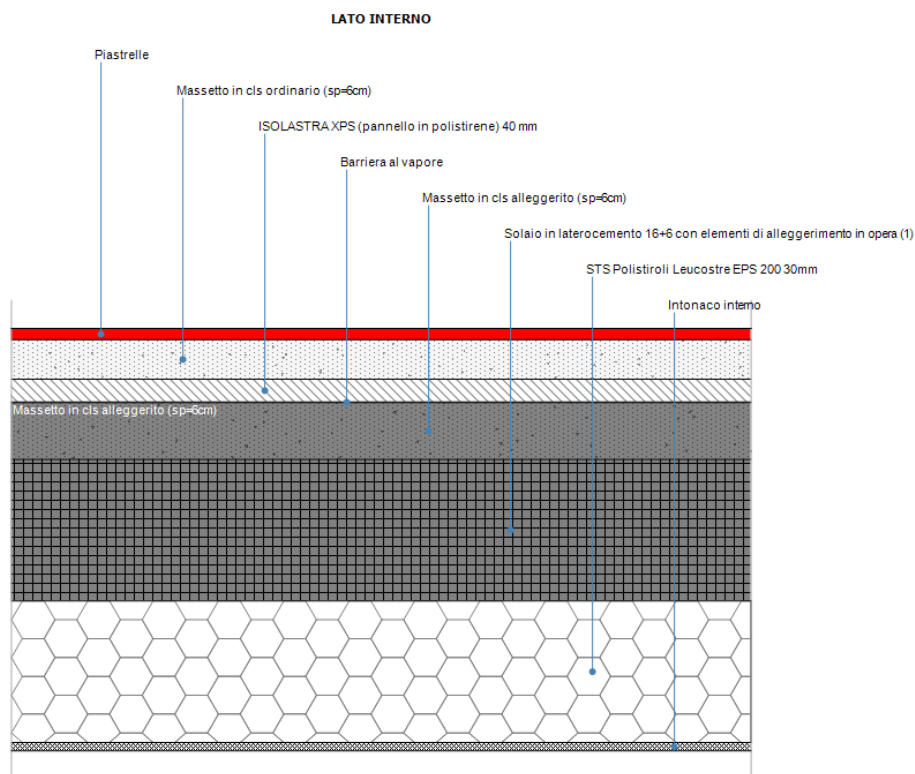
Sezione corrente del pavimento controterra isolato della zona riscaldata al piano terra
